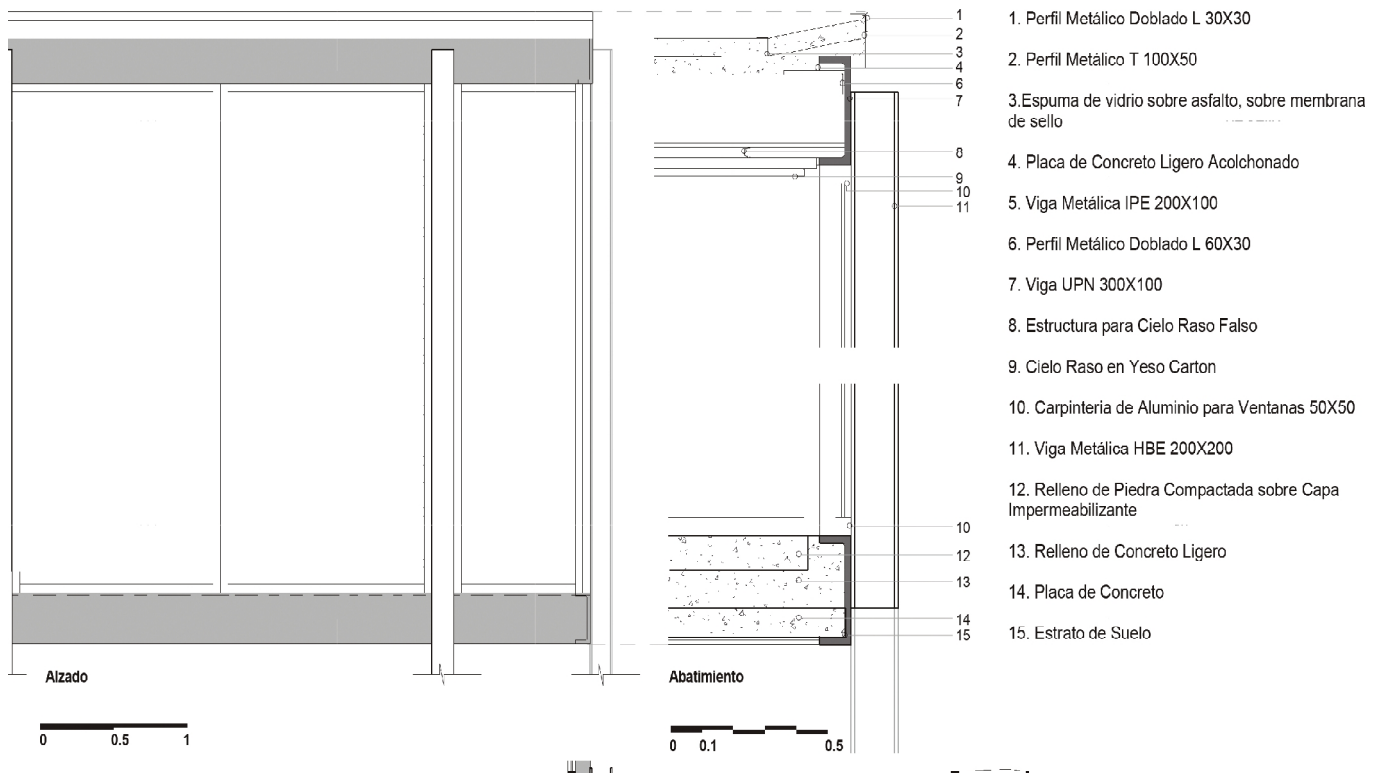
Reconstrucción del Detalle Constructivo Casa Farnsworth
